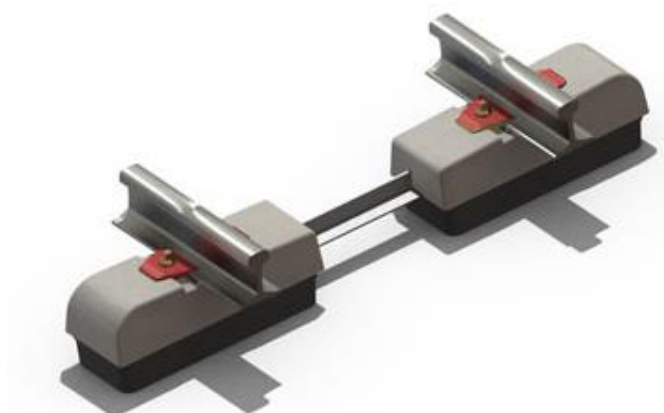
Traviesa Stedef (Fuente: <http://www.railtechsufetra.es>)
